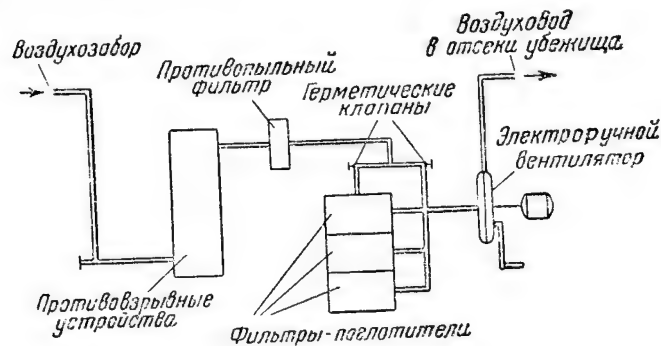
Принципиальная схема фильтро-вентиляции убежища
